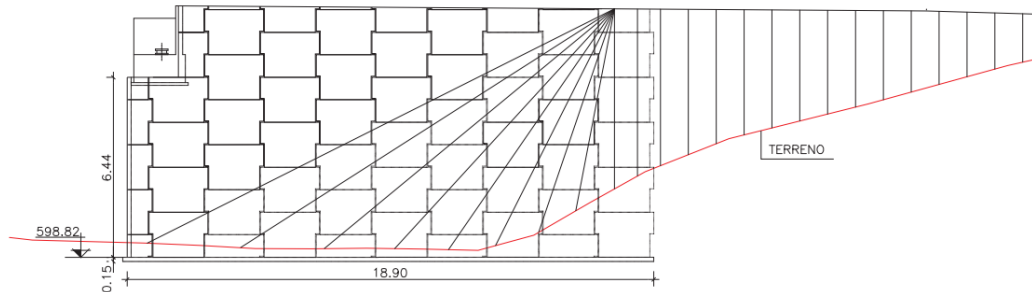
Alzado estribo 2 pasarela peatonal en la vía verde
